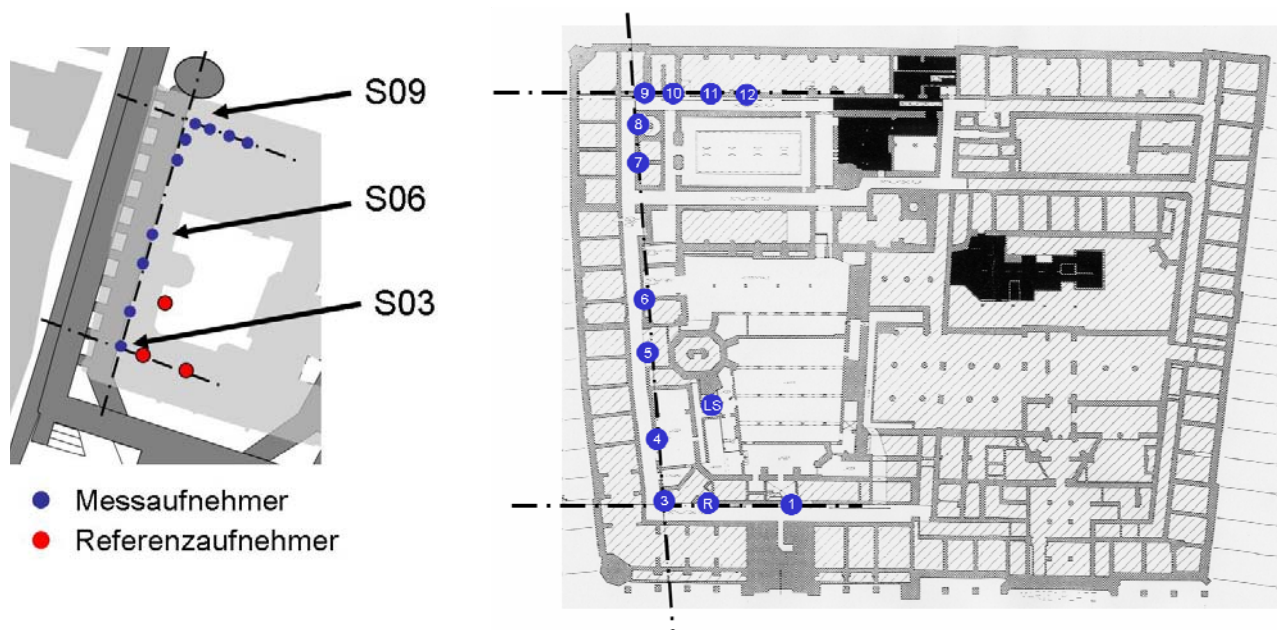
a und b: Lage der Messpunkte relativ zu den Tunneln und im Grundriss des 2. Kellergeschosses
